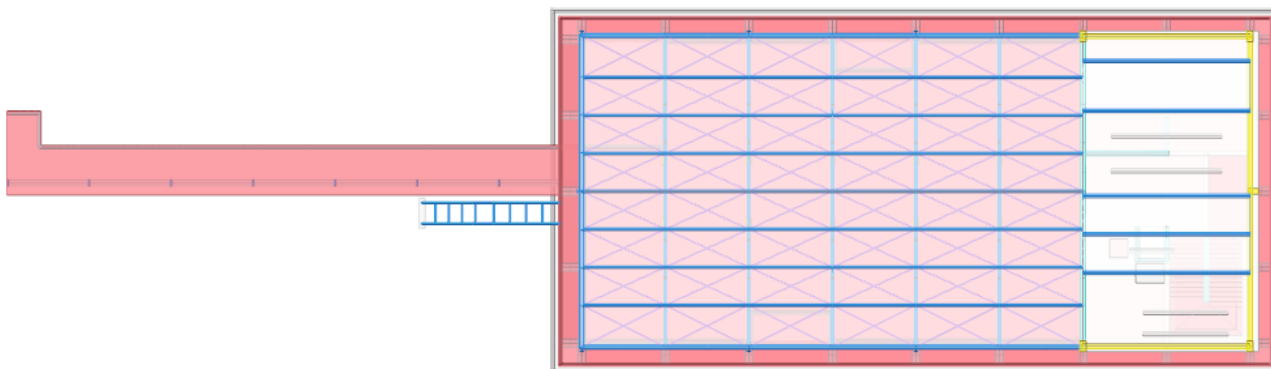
Vista 3D del Modello Strutturale FEM – Corpo A+B – Vista in Pianta – Stato di Progetto
